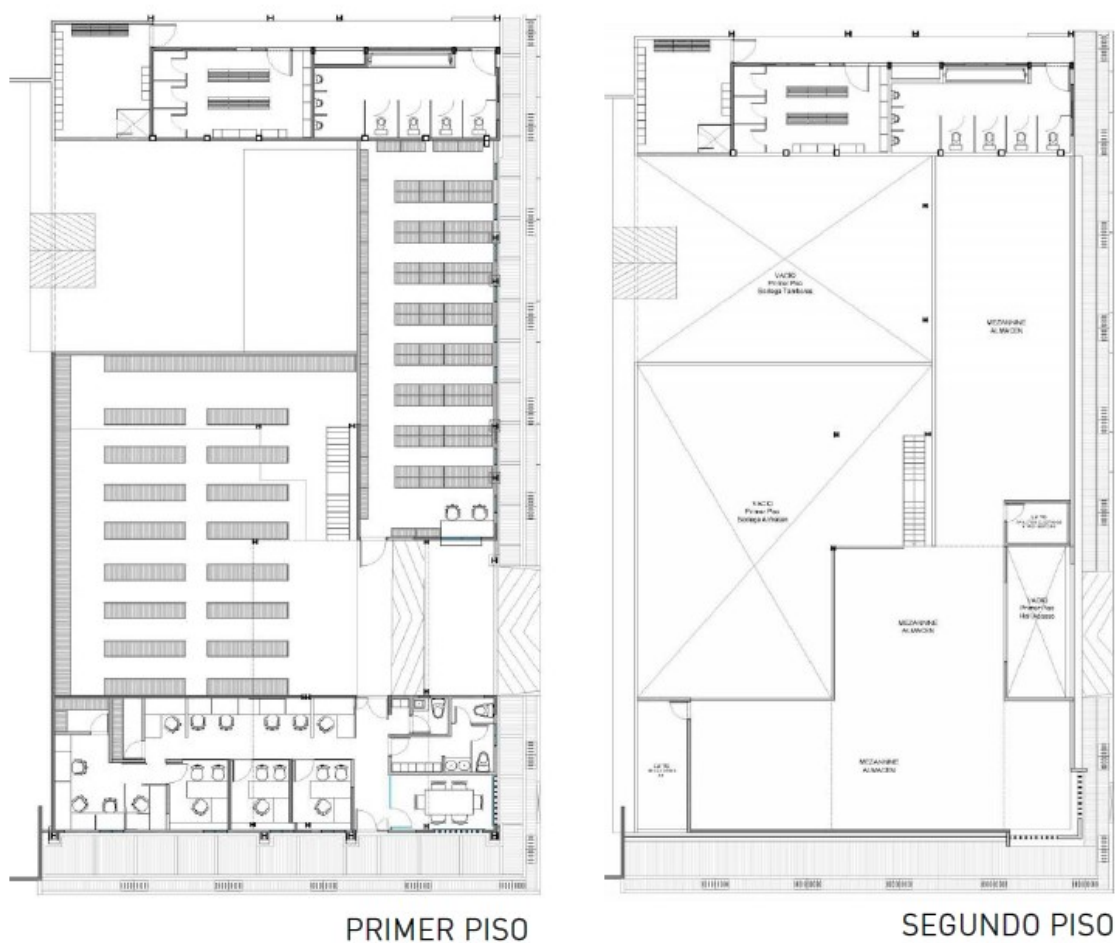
Planimetrías bodegas Graficacion Empresa 180°Arquitectos
